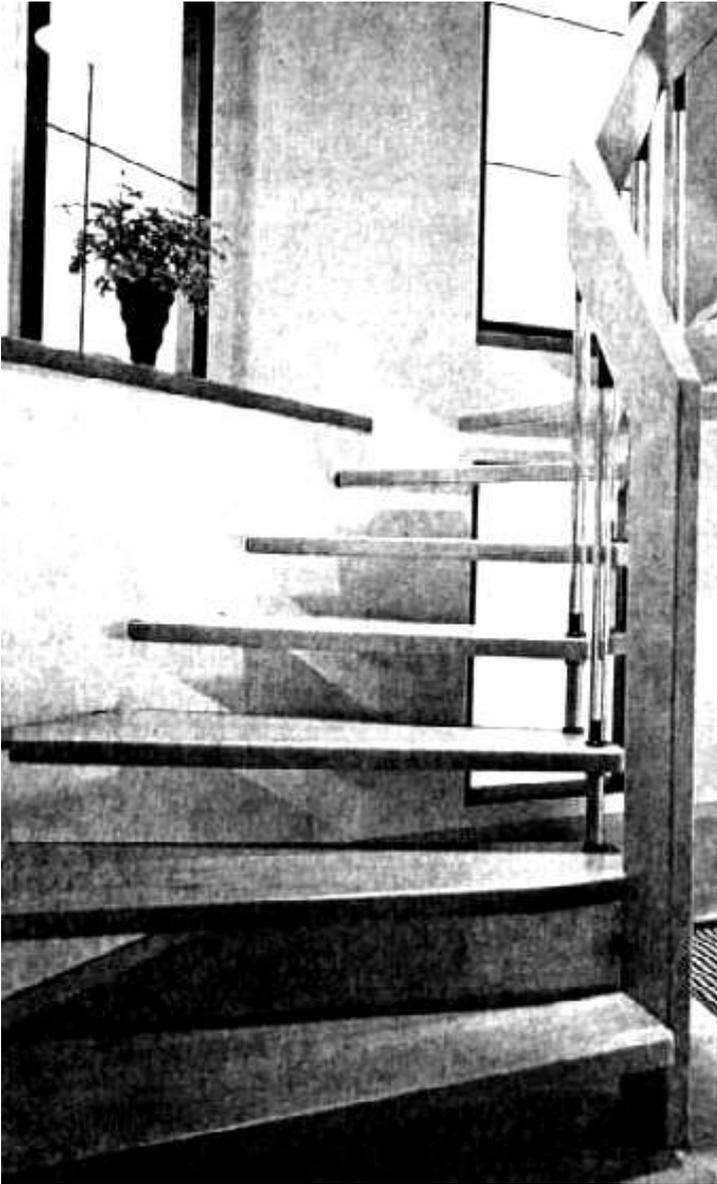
Жилой дом. Лестница с креплением ступеней к стене
